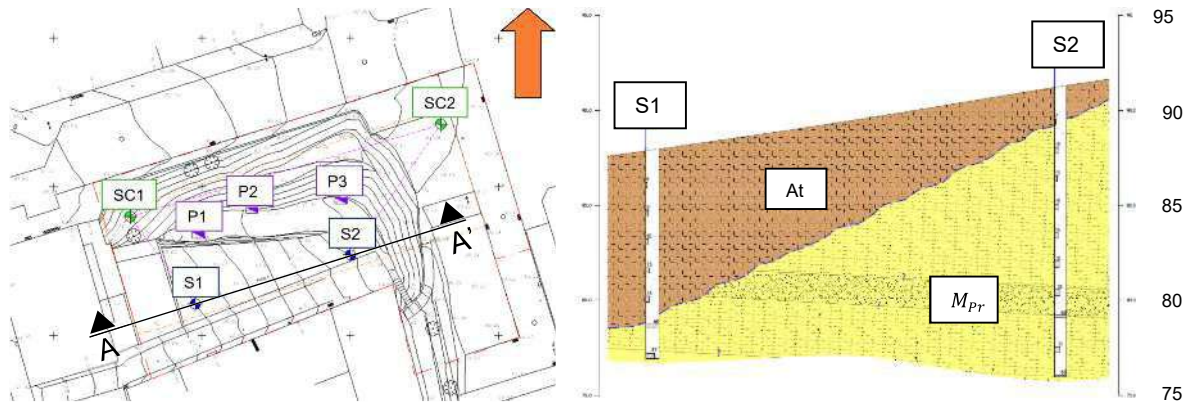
Planta de localização e prospeção geológica e perfil geotécnico interpretativo A-A'.
